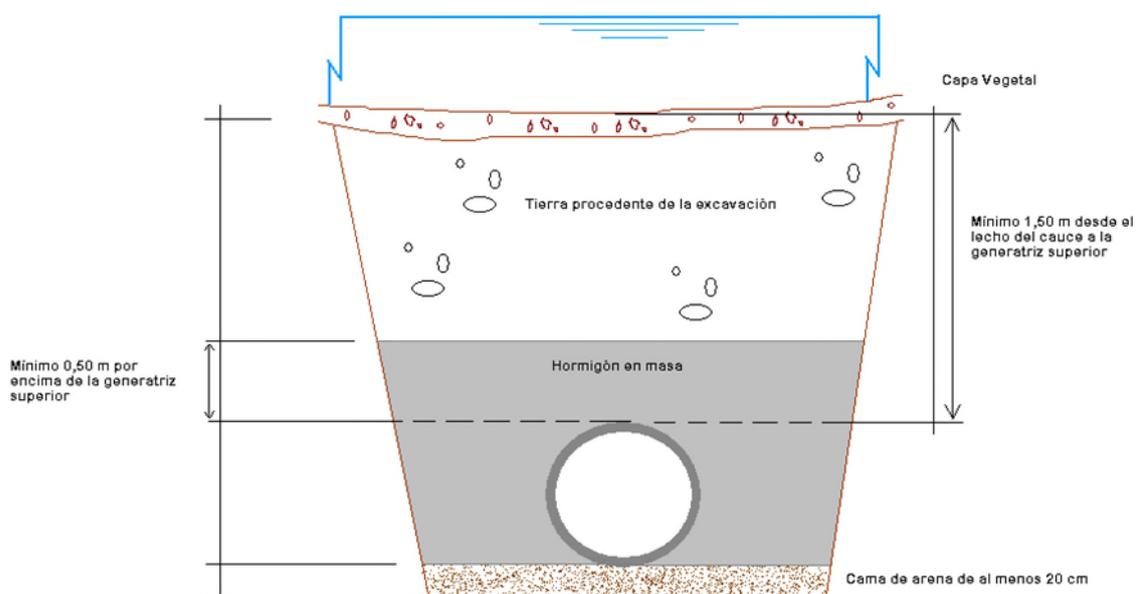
Esquema de colocación de una conducción subterránea con las distancias mínimas de relleno de la conducción y de la generatriz de la conducción con el lecho del cauce.
